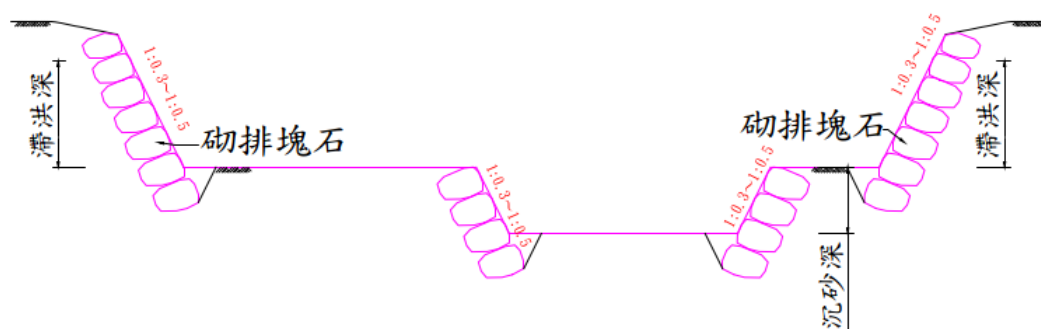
水庫防淤 - DET1 滯洪沉砂池 B 剖面圖
